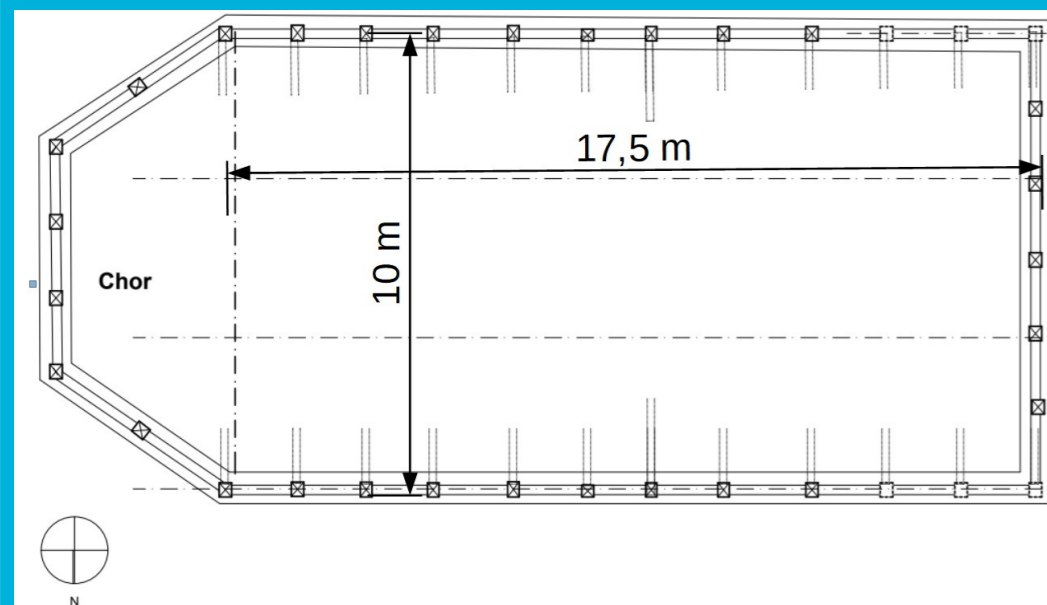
Rekonstruktionsvorschlag der ehemaligen Fachwerkstruktur - Grundriss
